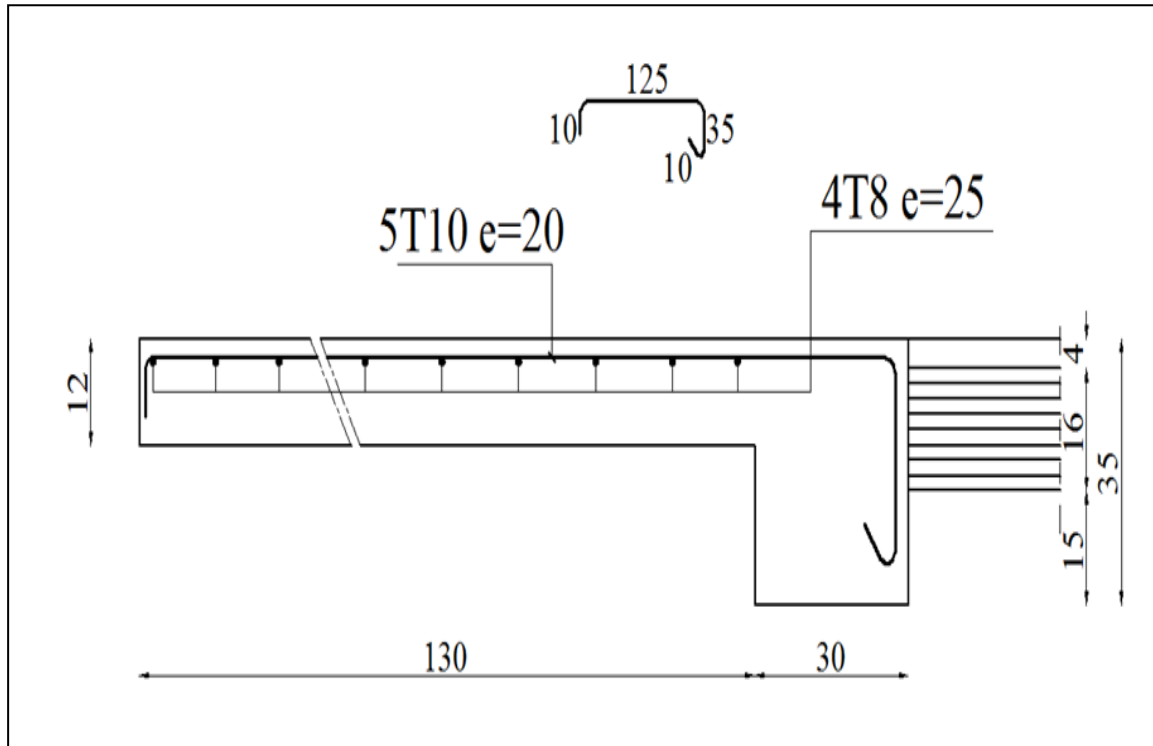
plan de ferrailage du balcon(Niveau terrasse) .
